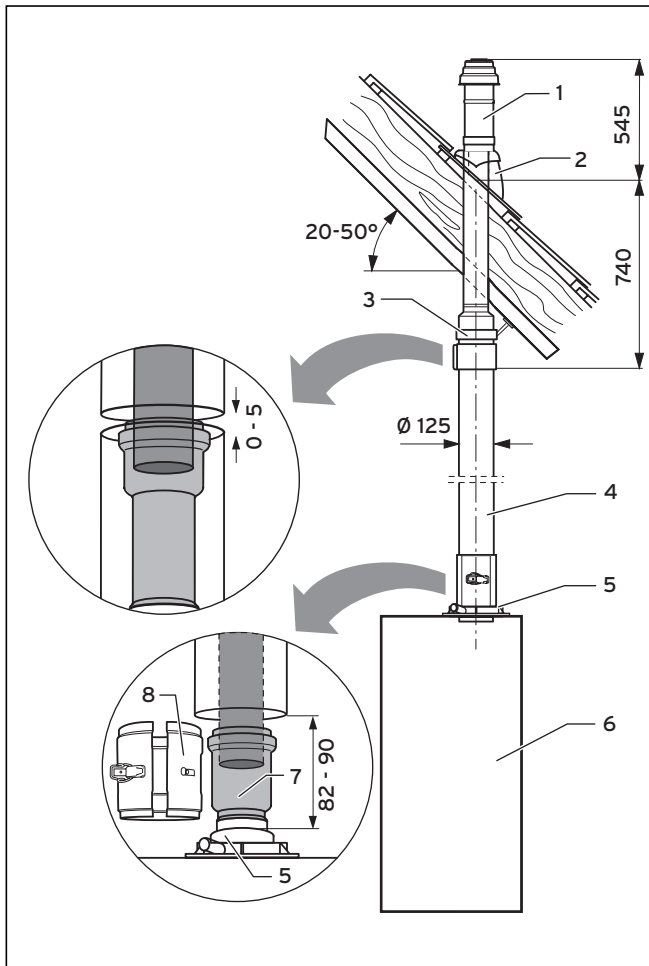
Монтаж прибора и кровельного ввода при наклонных крышах
